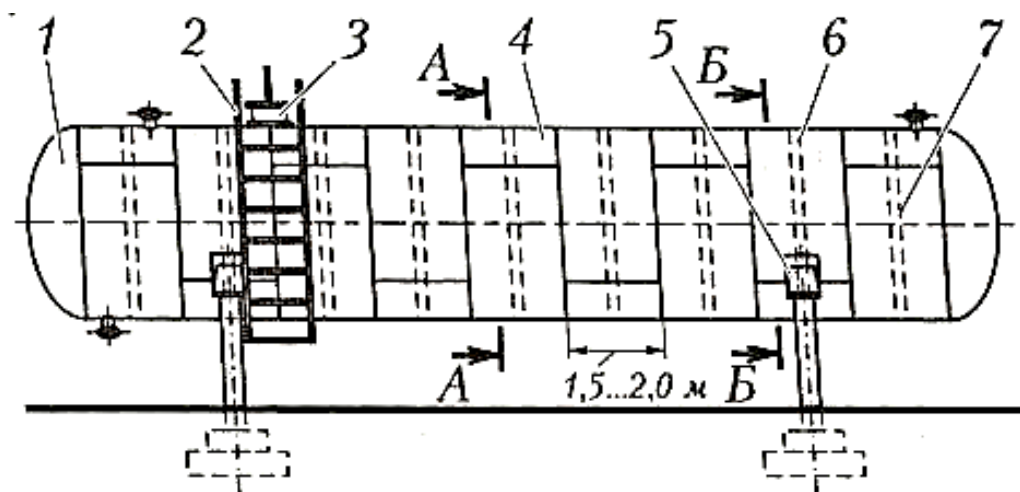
Загальний вигляд горизонтального резервуара для зберігання ЗГ [2]
